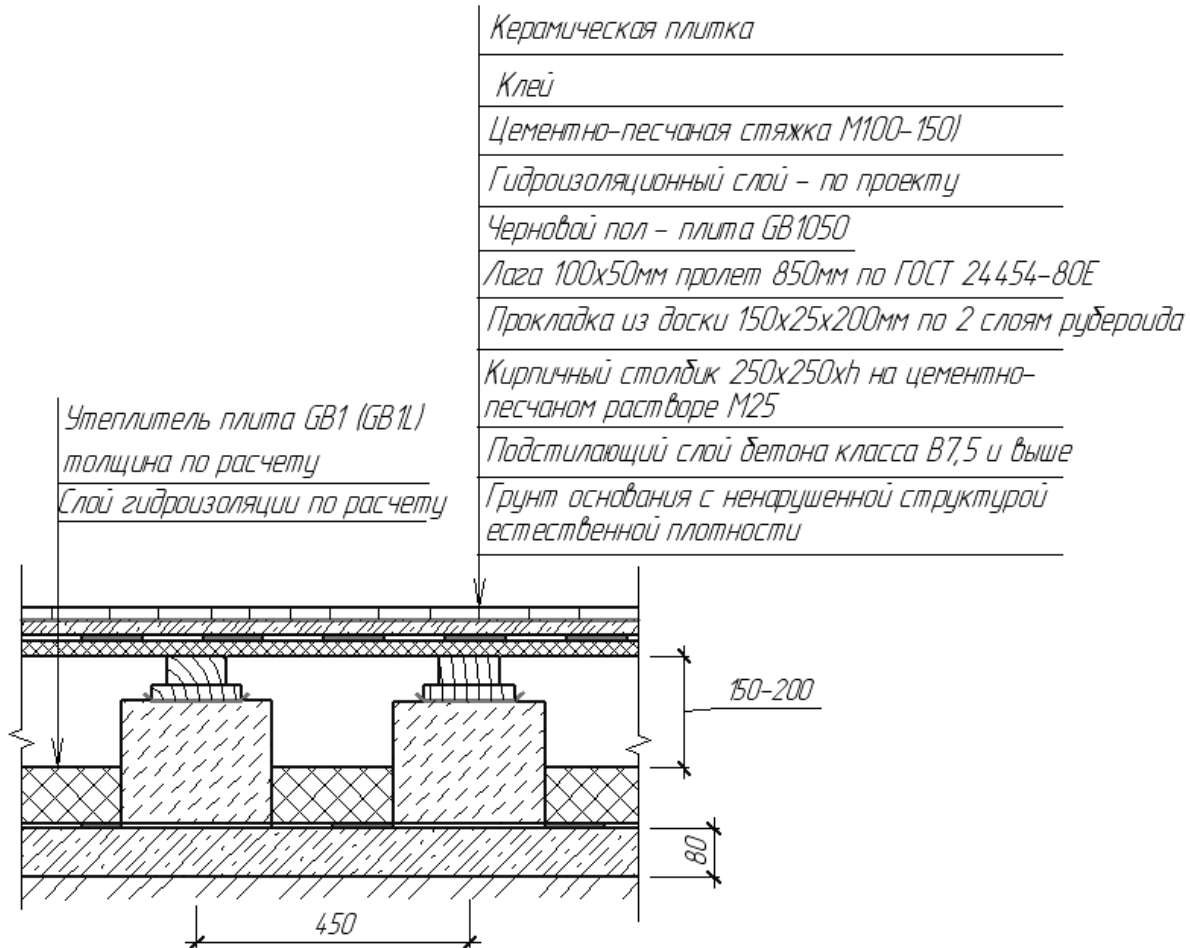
Конструкция плиточного пола №1 по грунту с утеплением на кирпичных столбах с применением системы плит GREEN BOARD®
